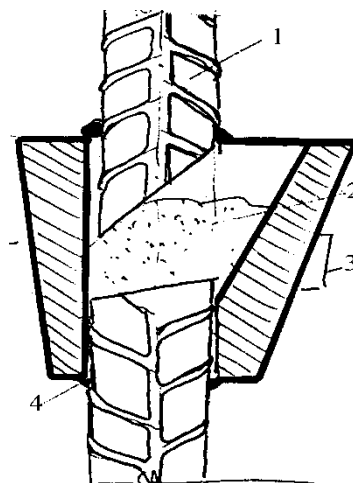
Полуавтоматическая сварка под слоем флюса:
